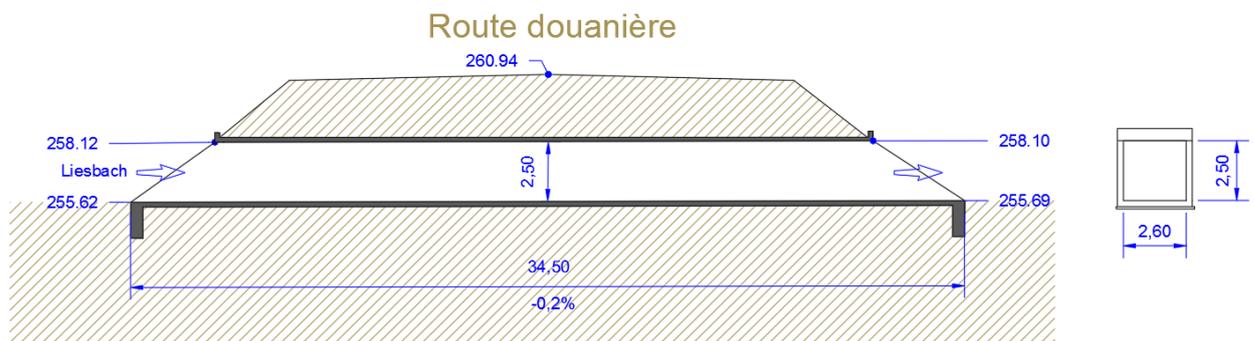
Coupe de l'ouvrage OA25 (Source plans DIR EST 1986)
